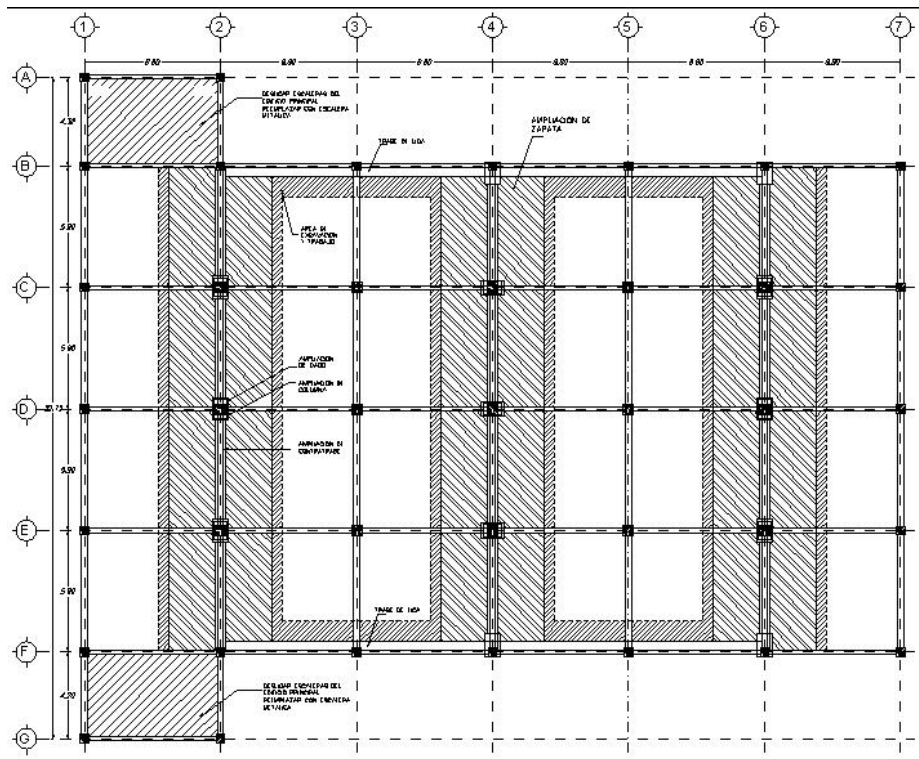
Vista en planta de la cimentación, de las contratrabes y zapatas que se propone reforzar y de las áreas afectadas.
